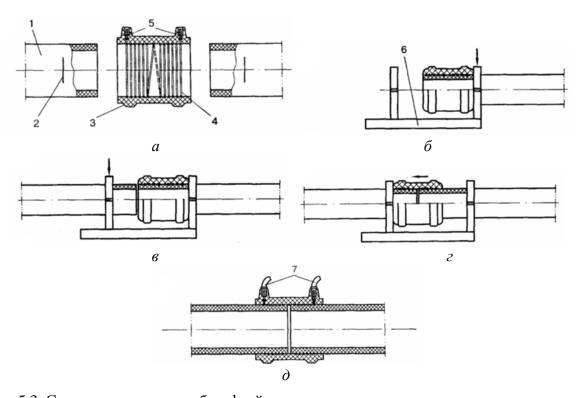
Схема соединения труб муфтой с закладным нагревателем: a — подготовка соединяемых элементов;  $\delta$ ,  $\epsilon$ ,  $\epsilon$  — этапы сборки стыка;  $\delta$  — собранный под сварку стык: l — труба; d — метка посадки муфты и механической обработки поверхности трубы; d — муфта; d — закладной нагреватель; d — клеммы токопровода; d — позиционер; d — токоподводящие кабели сварочного аппарата
